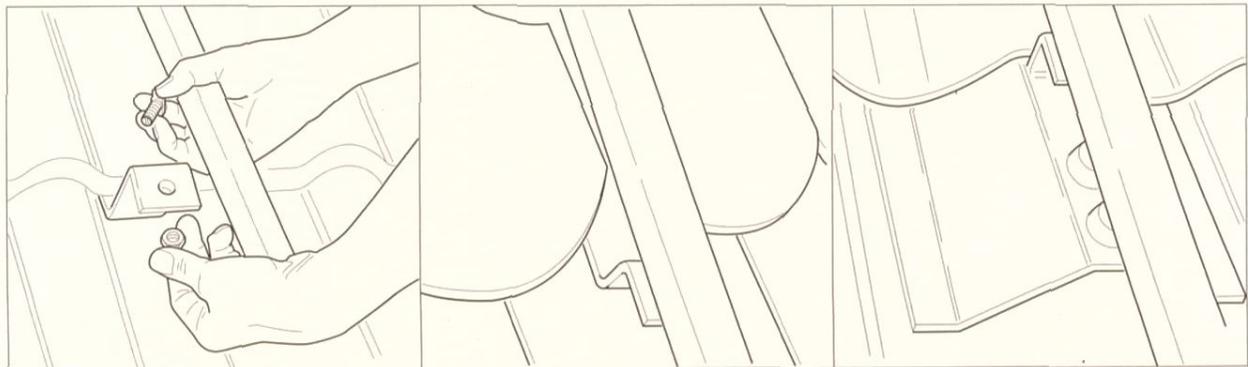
Sparrenanker-Typen für verschiedene Dacheindeckungen: für Frankfurter Pfanne (links) mit Montageschiene und Hammerkopfschraube für die sichere Dachverbindung, für Biberschwanz oder Schiefer (Mitte) und für Berliner Welle W90 (rechts).
